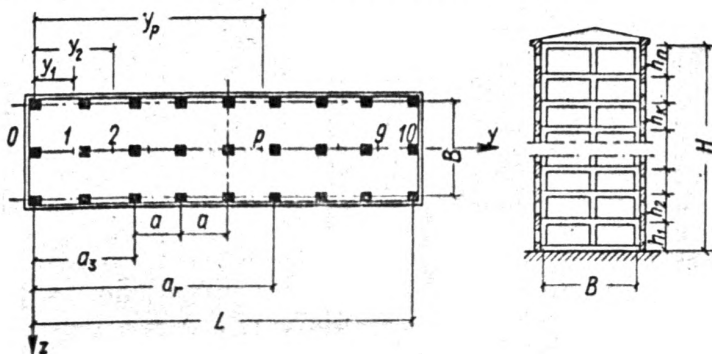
План и поперечный разрез каркасного здания рамной конструктивной схемы
